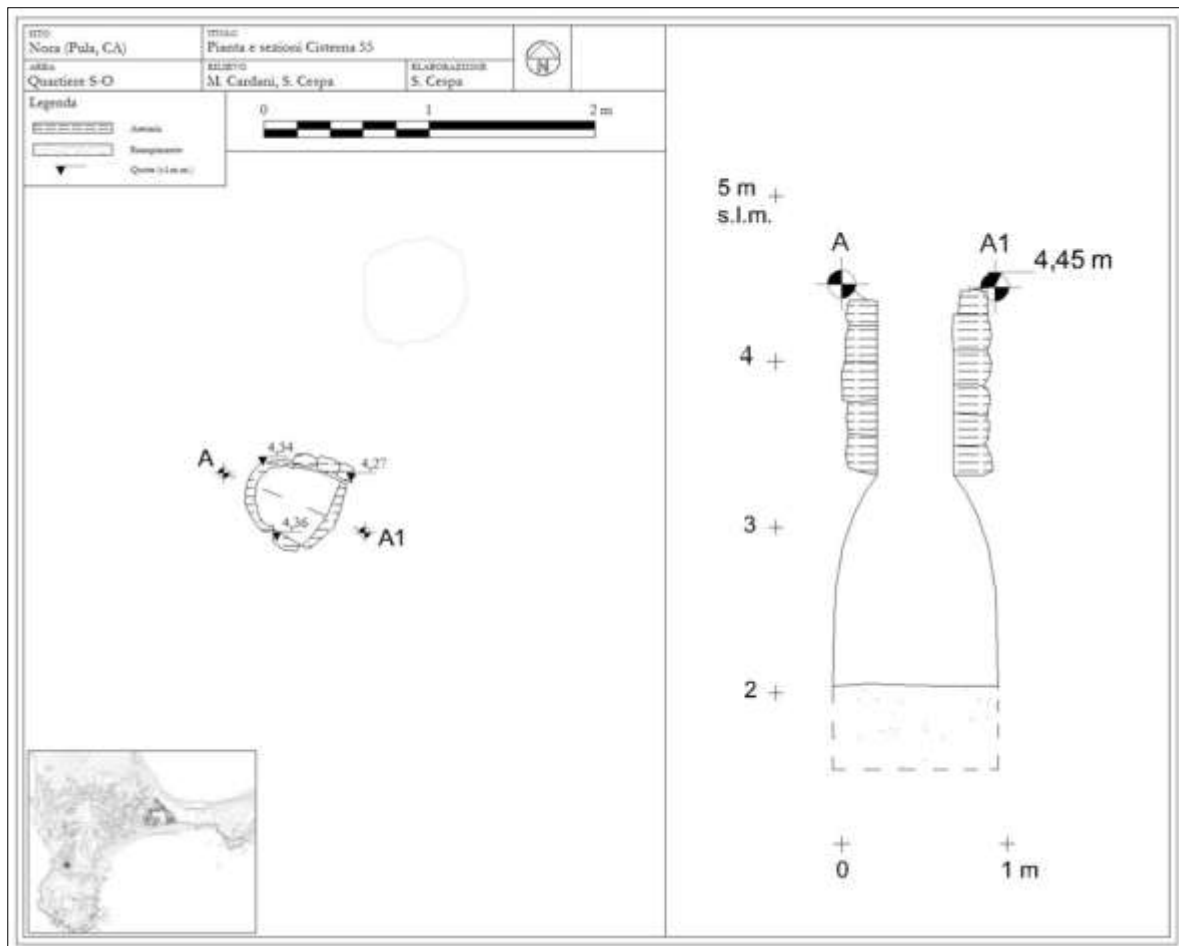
Pianta e sezione della cisterna 55 (elaborazione dell'autore).
